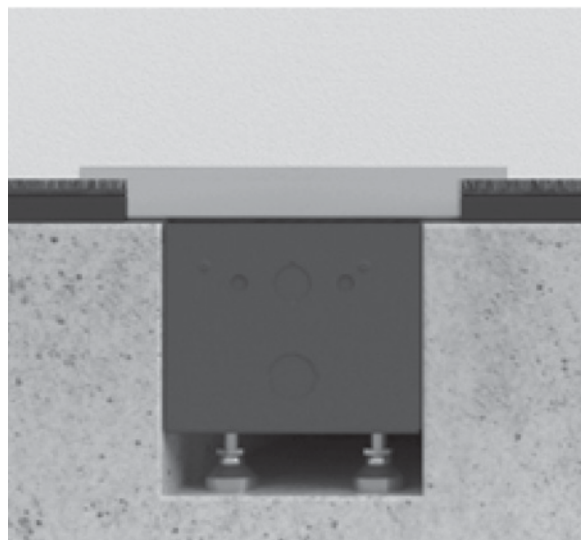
B : Montage en surface - La bride de la grille se trouve sur le dessus du plancher
